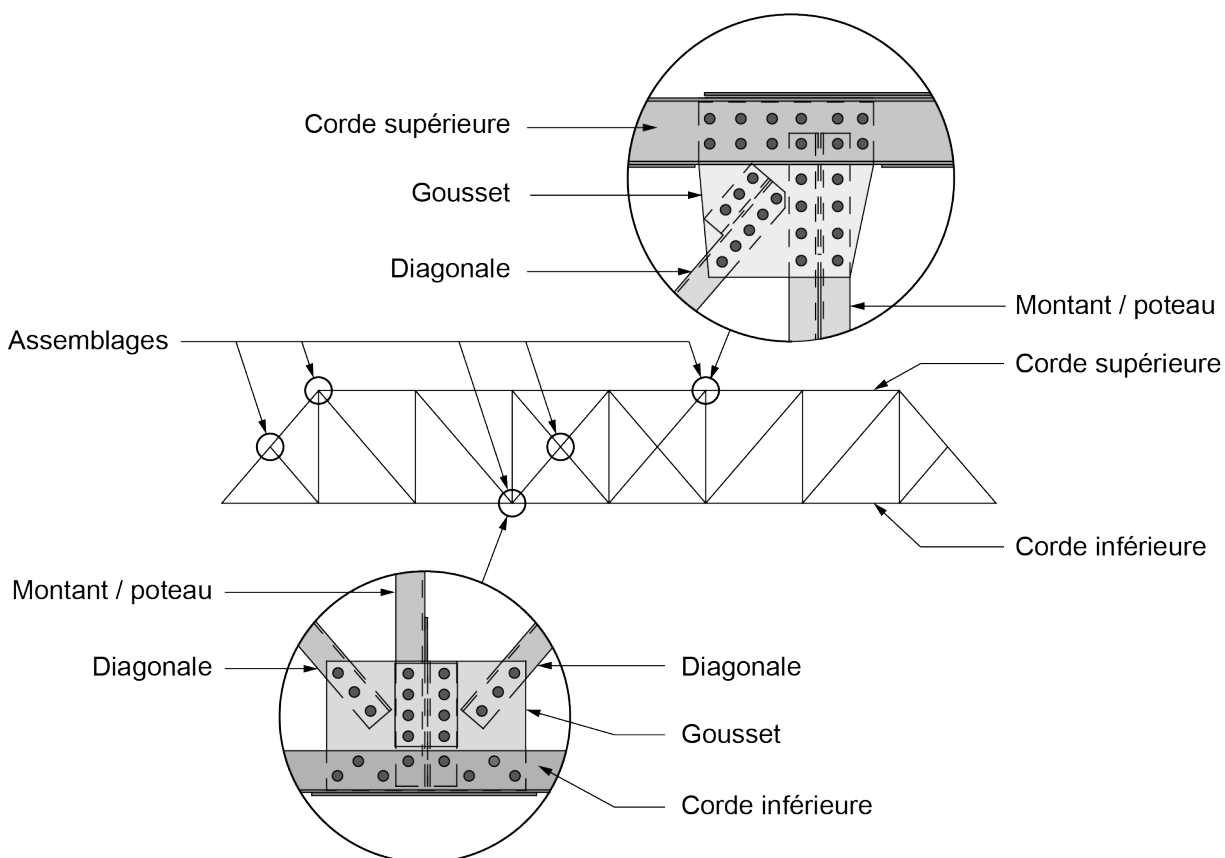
Assemblages d'une poutre triangulée en acier
